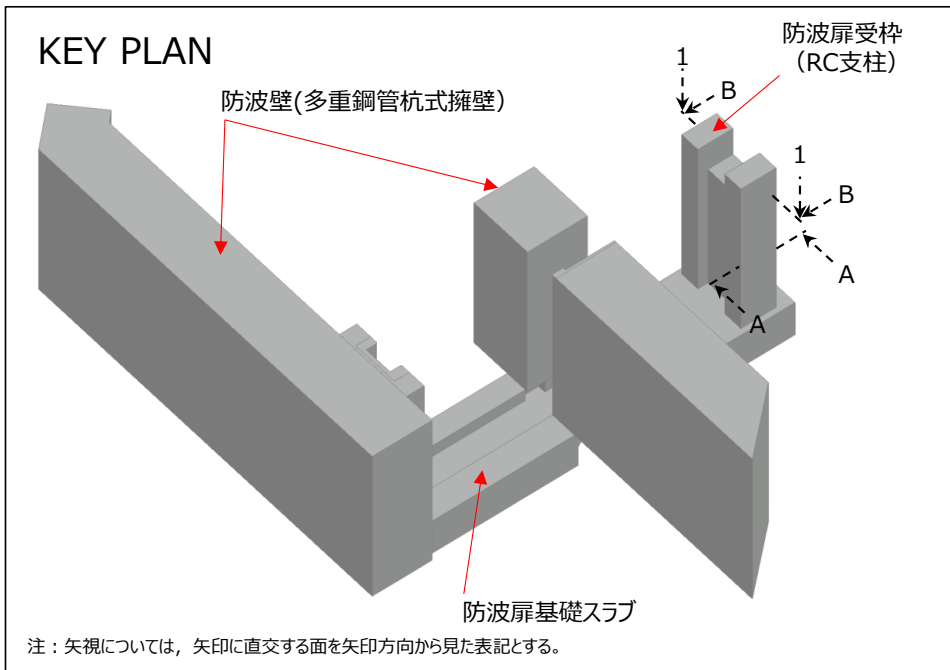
防波扉 (荷揚場南) の受枠 (RC支柱) の構造概要 (平面図)
